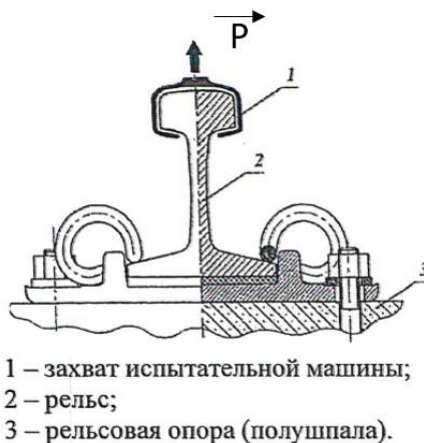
Схема испытания по определению усилия монтажного прижатия рельса к рельсовой опоре
